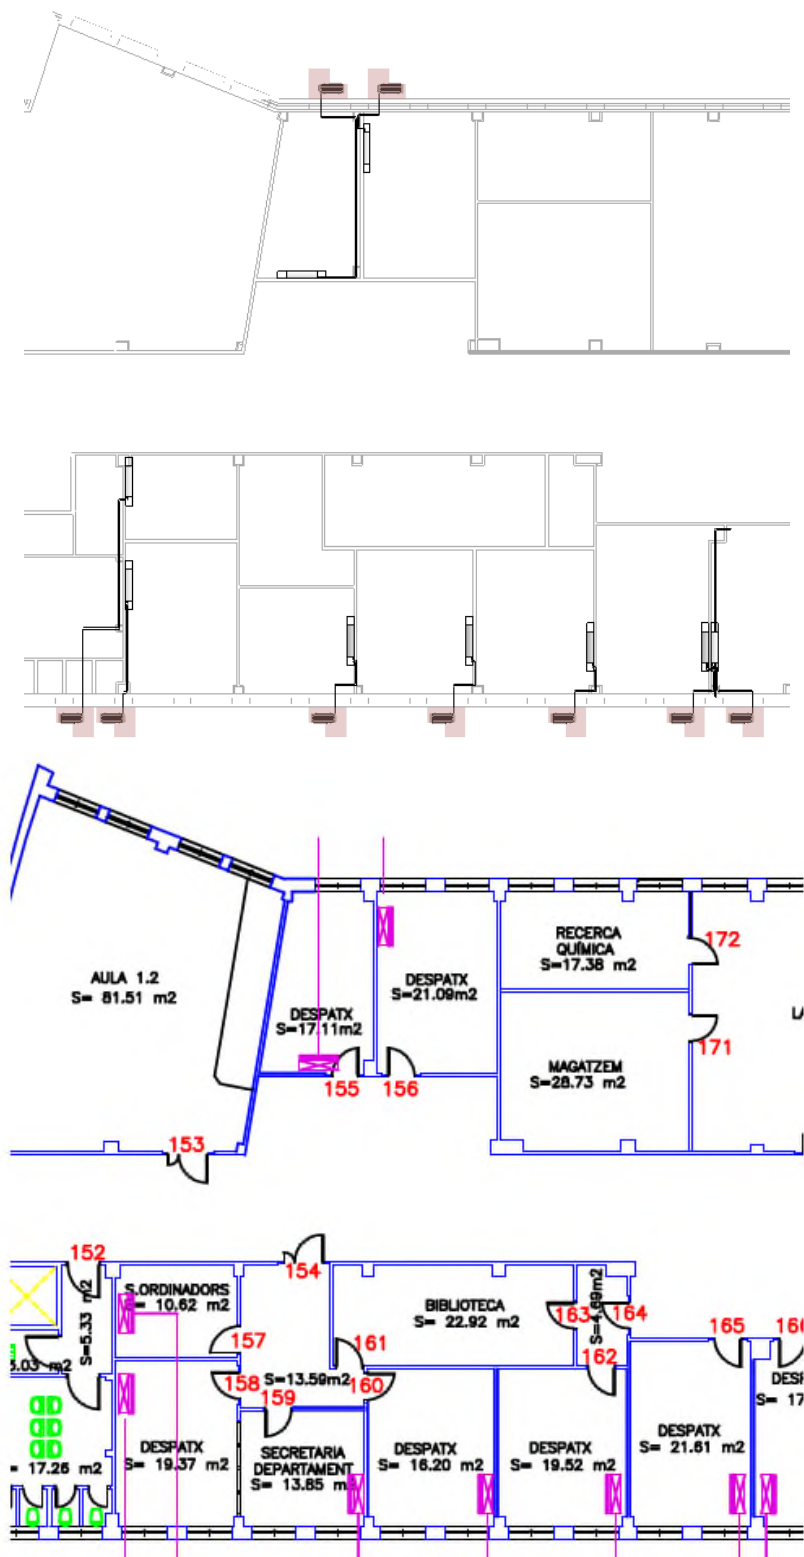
Modelado climatización primera planta (parte central de la universidad)
